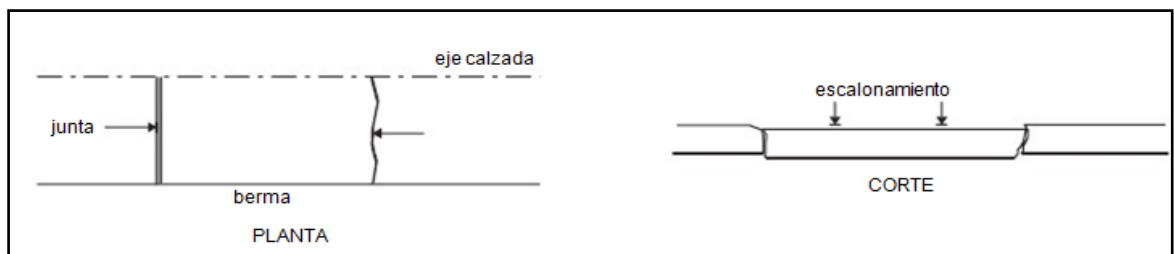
Vista en planta y Corte de Escalonamiento en juntas.
